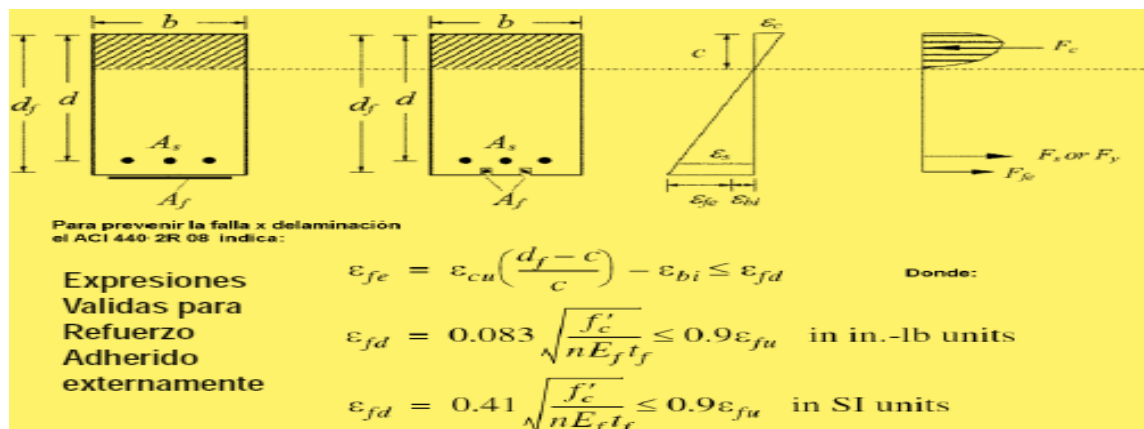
Refuerzo adherido externamente Delaminación. Fuente ACI 440 2R-8
